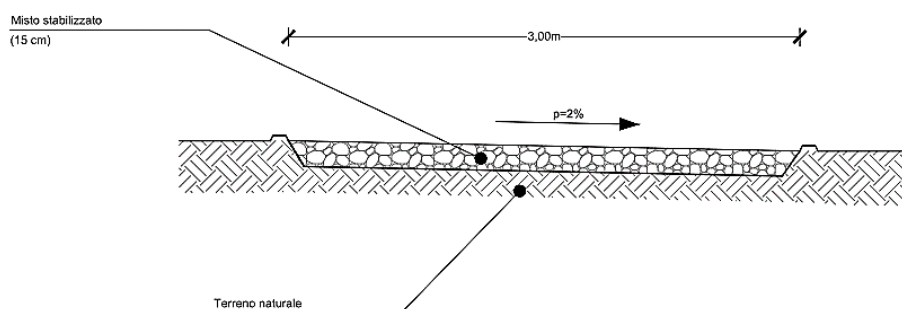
Sezione tipo strade interne al sito di progetto (Fonte: ns elaborazione)
